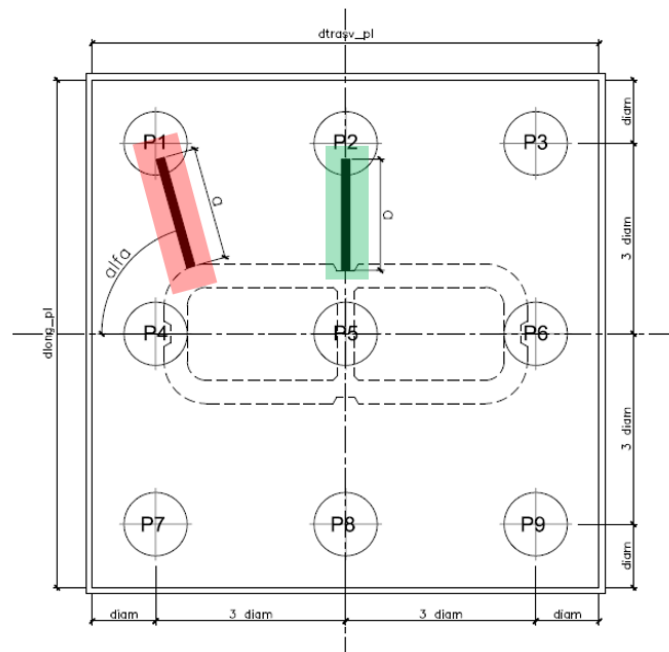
Vista in pianta - Tirante-puntone longitudinale (verde) e diagonale (rosso)
